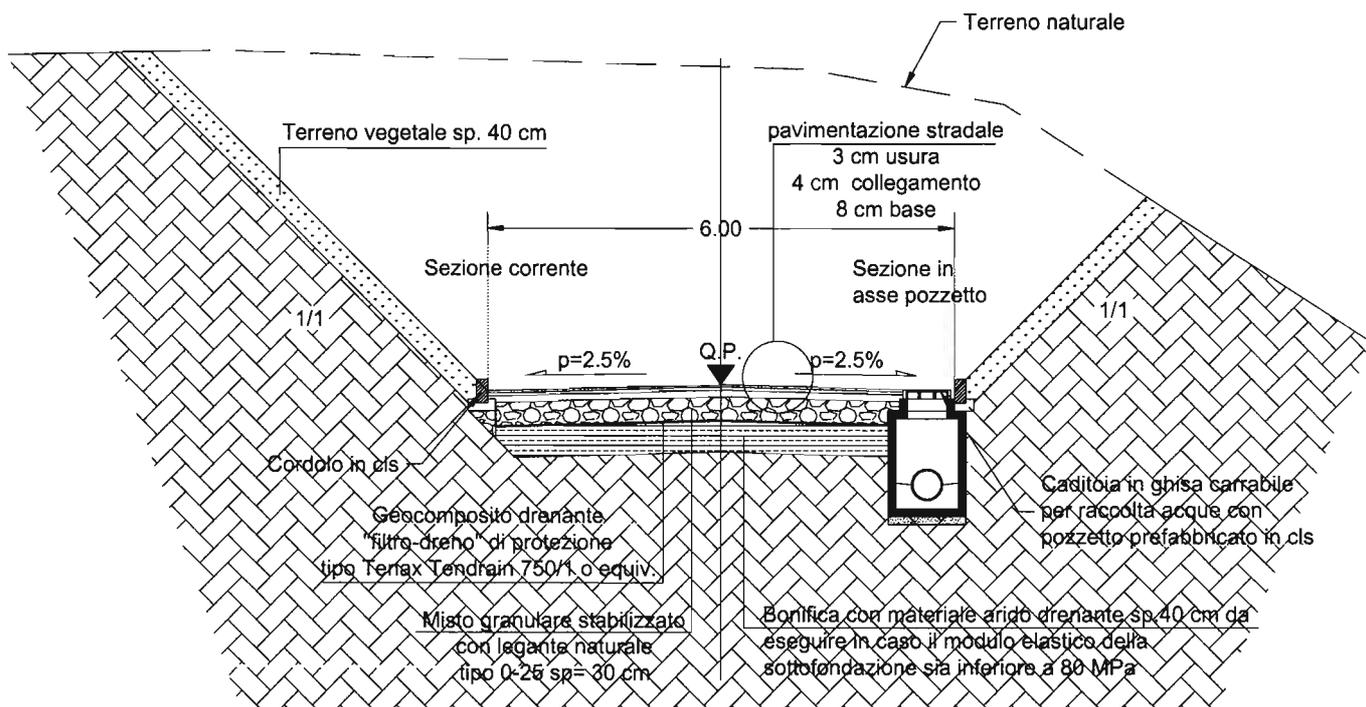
Sezione Tipo Strada Accesso Cantiere Chiusa
